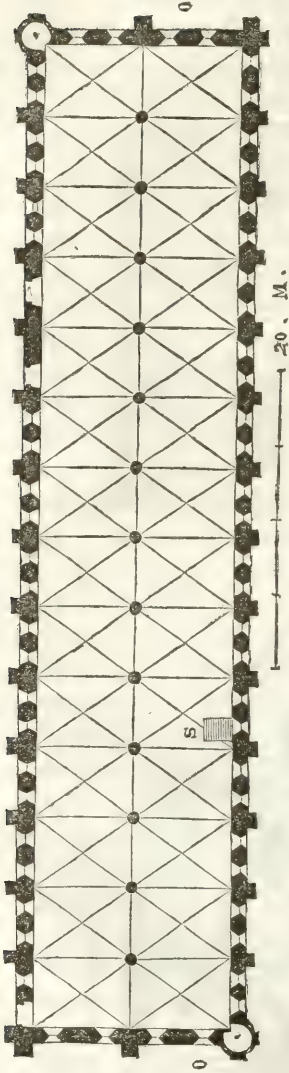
PLAN DE LA GRANDE SALE DU 1^{er}. ÉTAGE.
